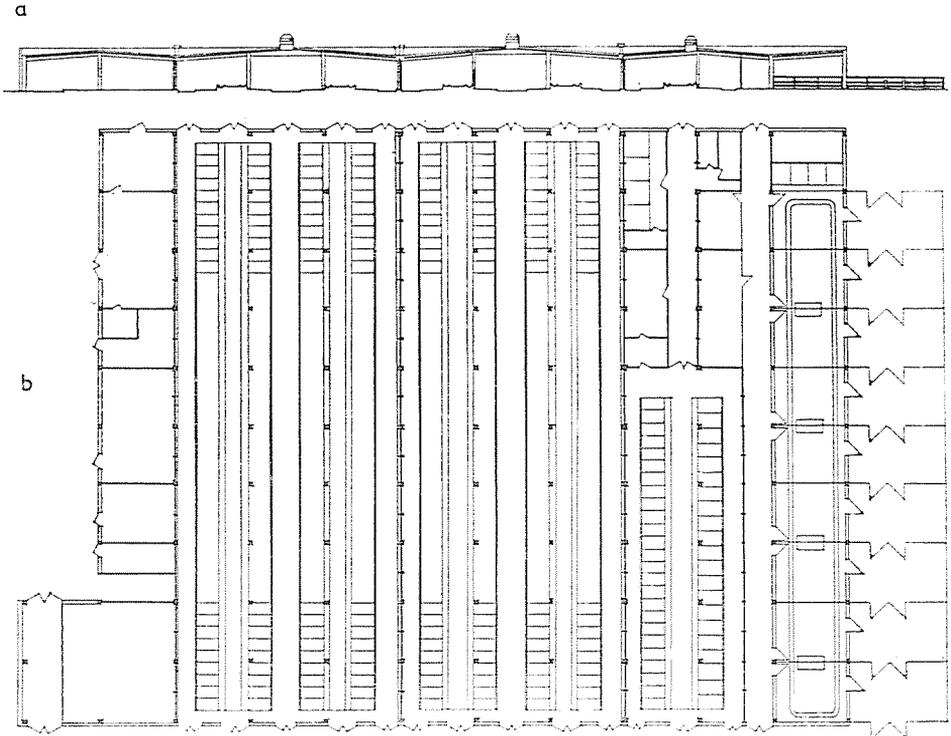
Plan eines kompaktierten Milchviehhaltungsbetriebes; a — Querschnitt; b — Grundriß
